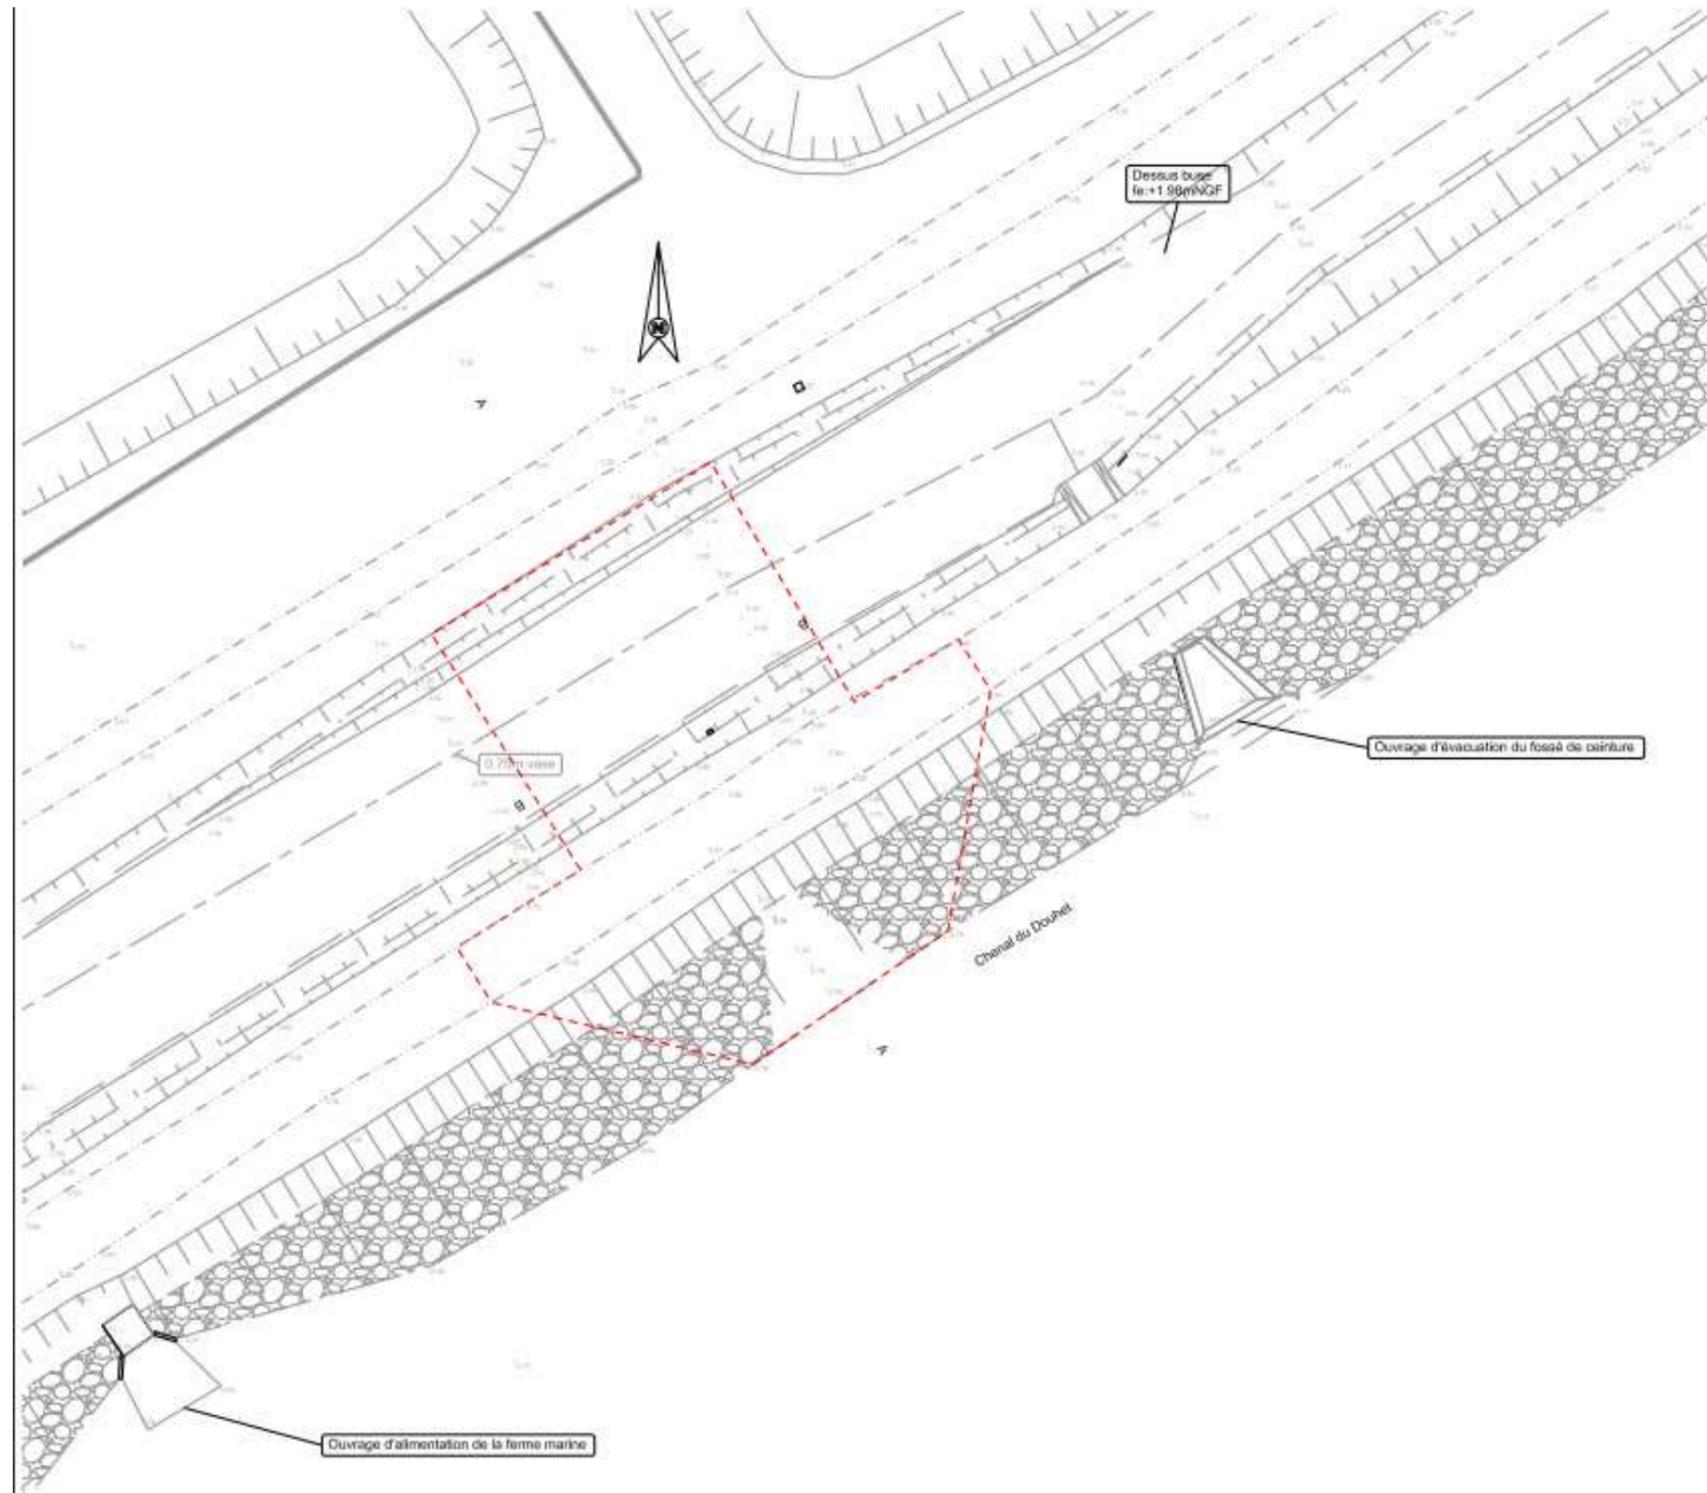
Vue en plan – Etat existant –UNIMA – Phase PRO (extraits)
